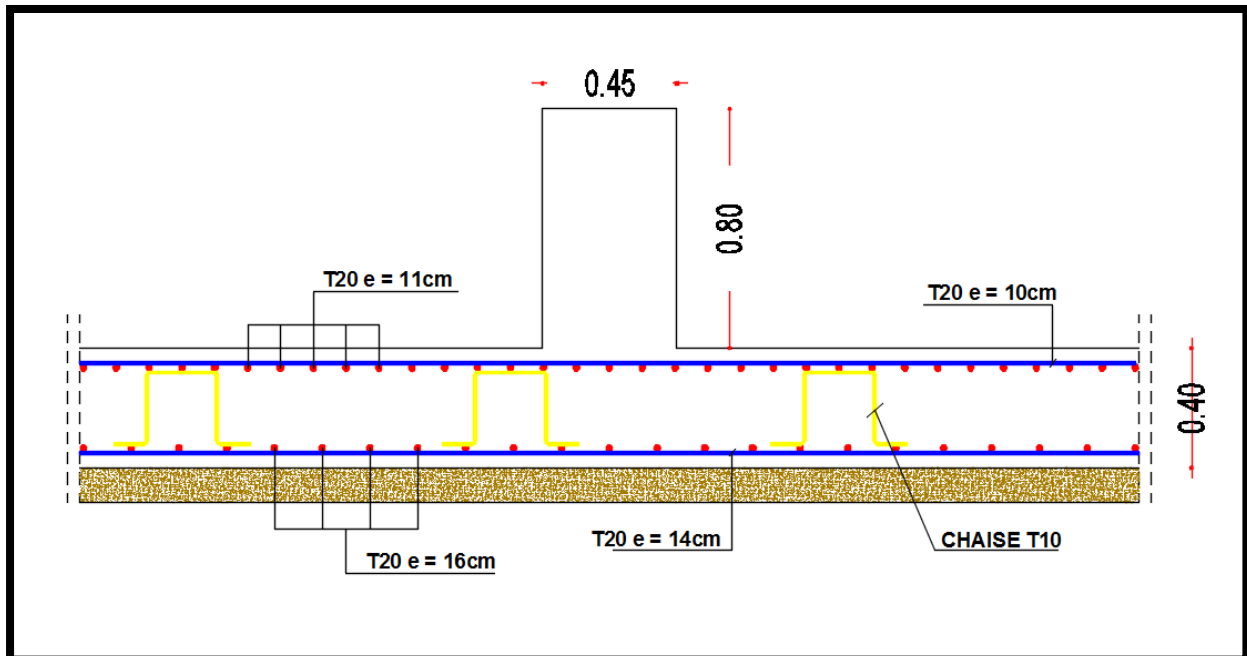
schéma de ferrailage de radier nervuré
